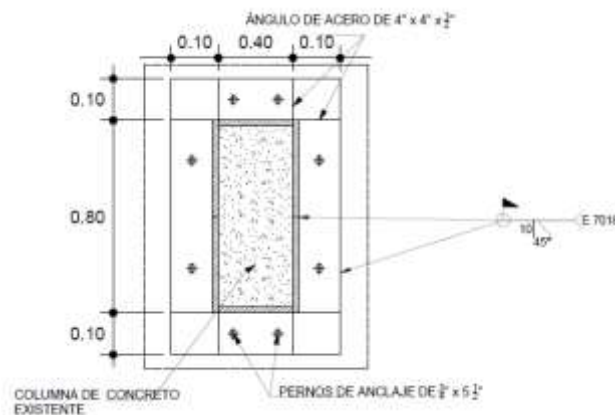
Detalle de refuerzo de columnas centrales de sótano, planta baja, primer y segundo nivel, Proyecto estructural.
